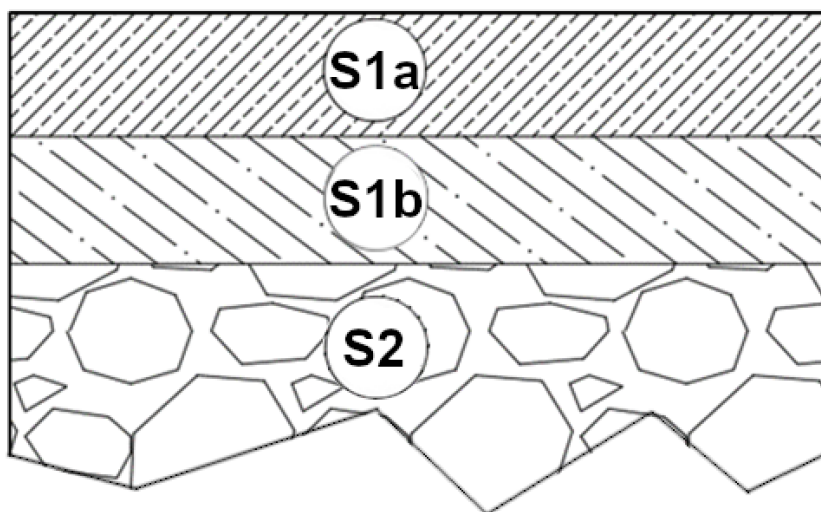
Representação esquemática da estrutura do pavimento ensaiado.
